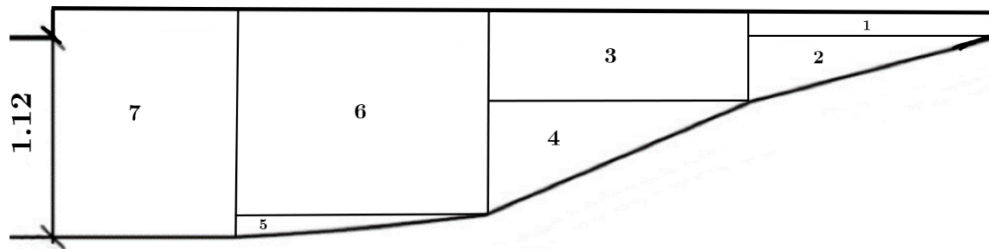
Coupe transversale de la demi-dalle divisée en sections pour calcul du centre d'inertie
